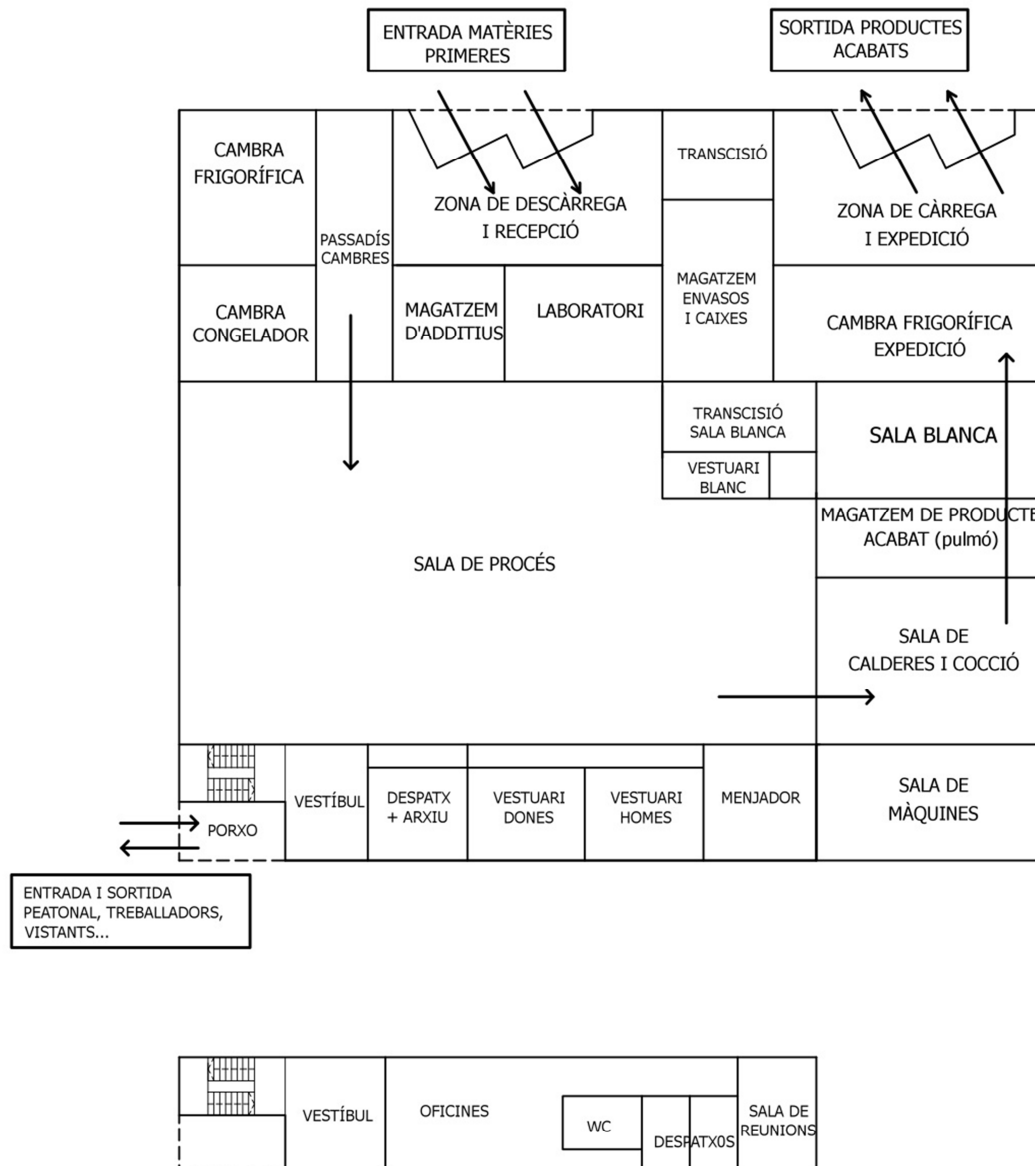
Croquis de la distribució en planta de la indústria projectada.
